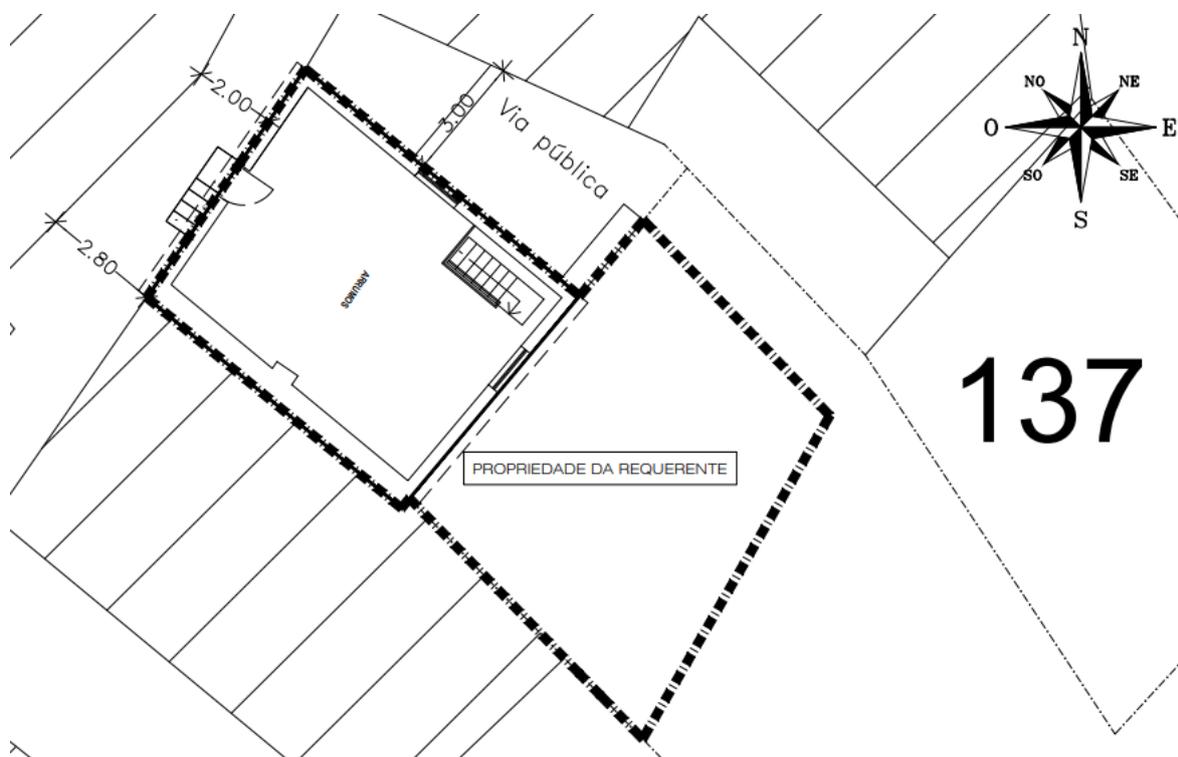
Planta de localização e implantação. Fonte: Maria Leonor.
